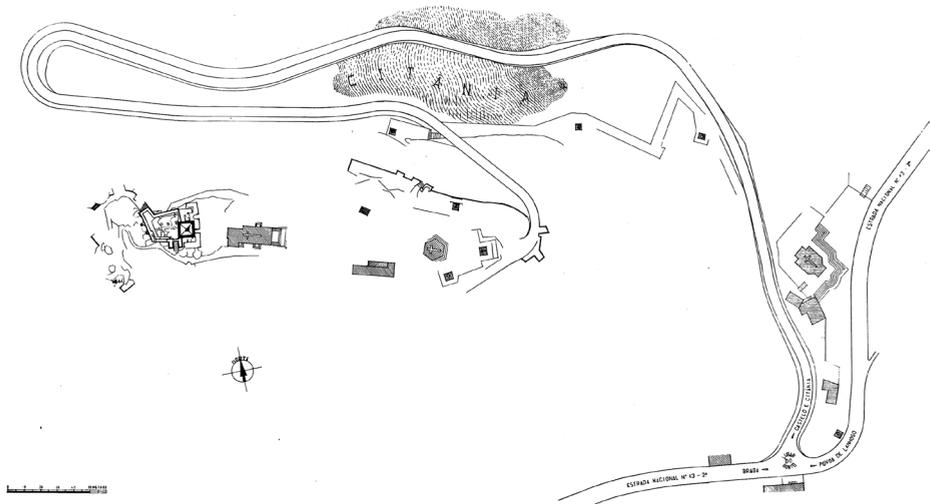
Castelo de Lanhoso, planta, depois das obras
